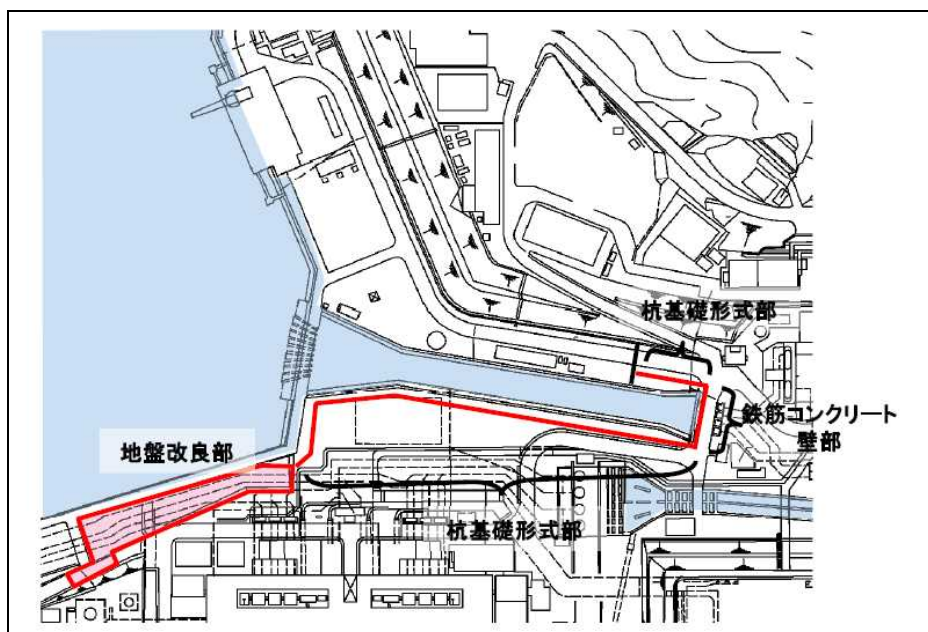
放水口側防潮堤平面図 (関西電力 高浜 1, 2 号炉)
